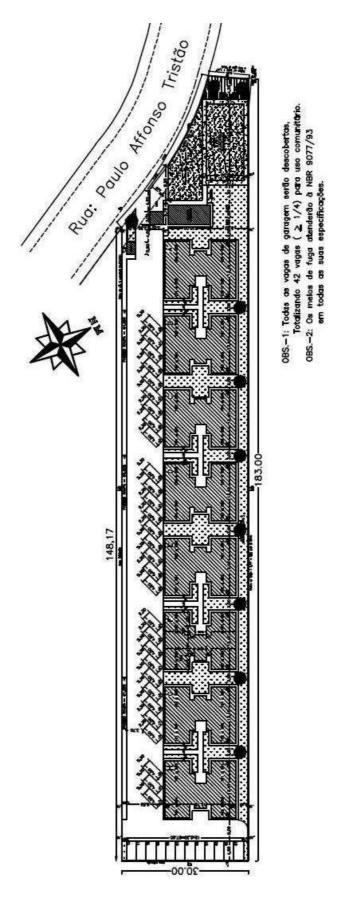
Planta de situação do Residencial Vivendas do Retiro (sem escala).
